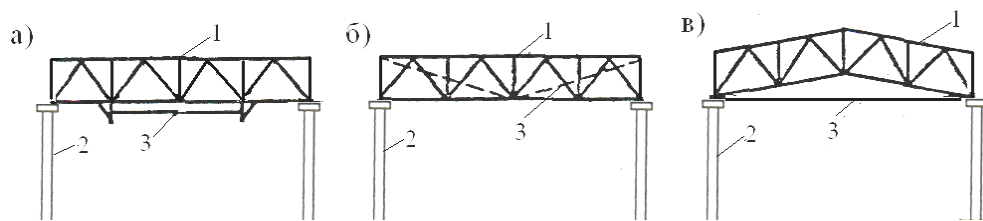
Усиление стропильных ферм путем установки преднапряженных затяжек: а)- при расположении вдоль нижнего пояса фермы; (б) и (в)- то же, в плоскости фермы при креплении затяжек в верхних и нижних опорных узлах фермы:
